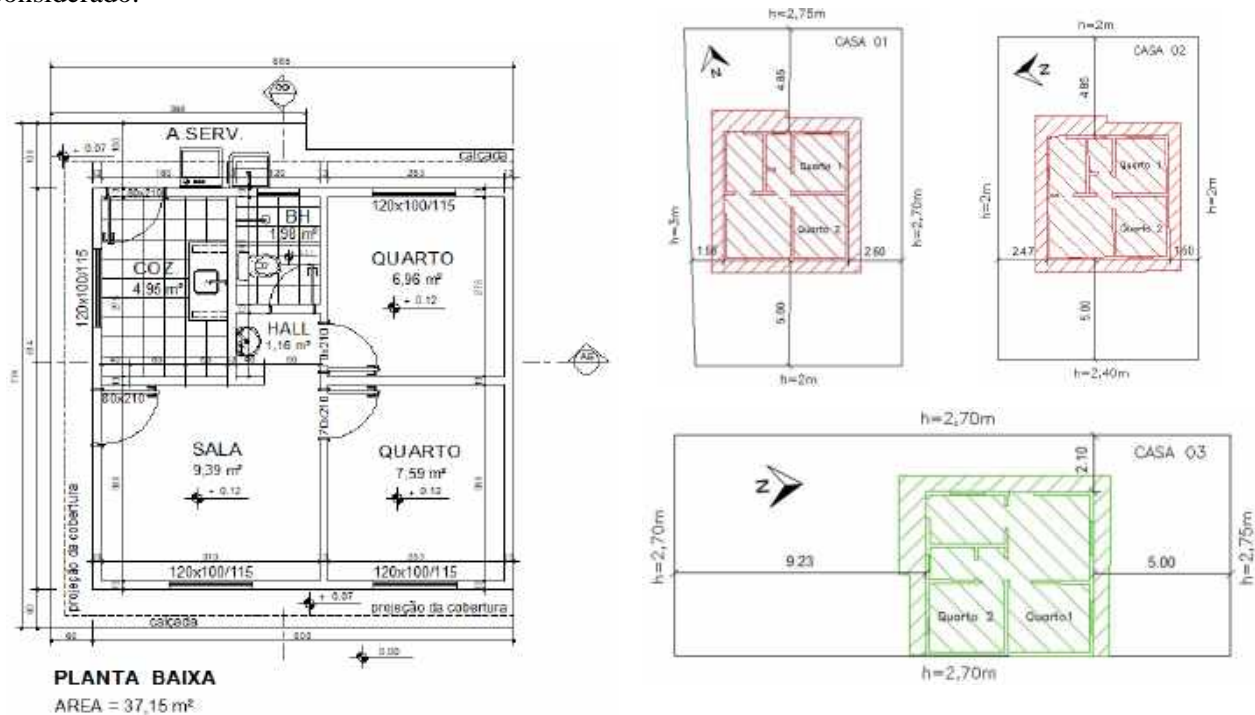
Planta baixa e divisa das edificações escolhidas (Adaptado do Projeto Arquitetônico - Tipo I)
